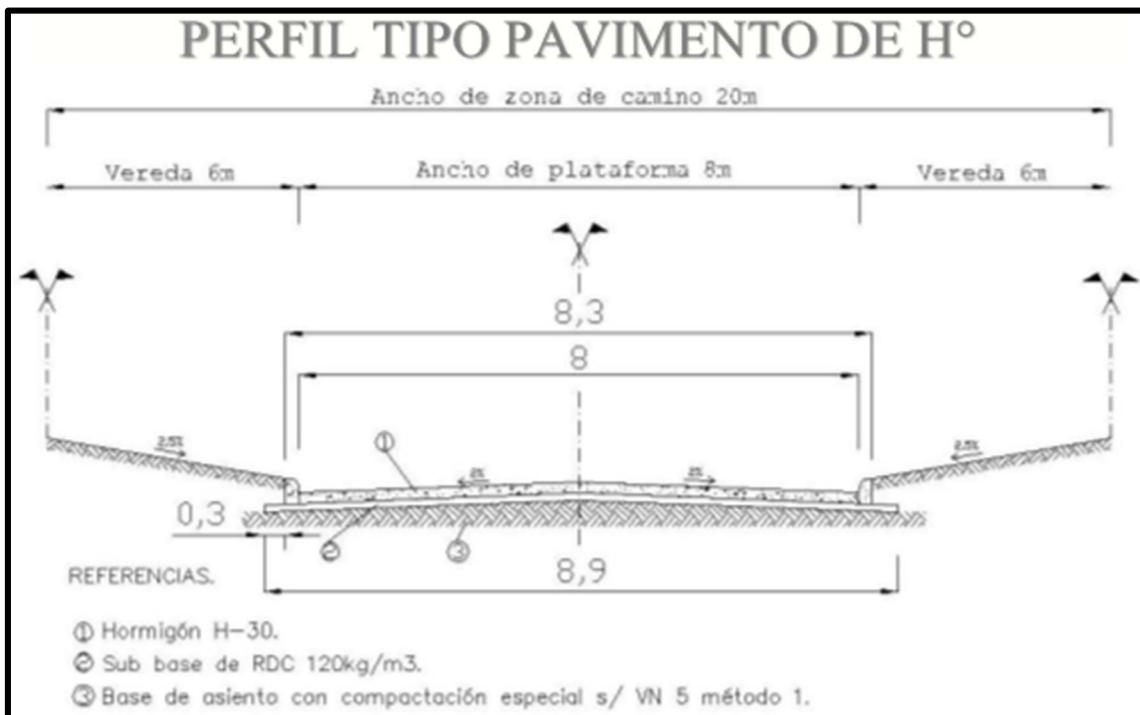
Perfil tipo de calle de pavimento de hormigón (fuente: DVP).
